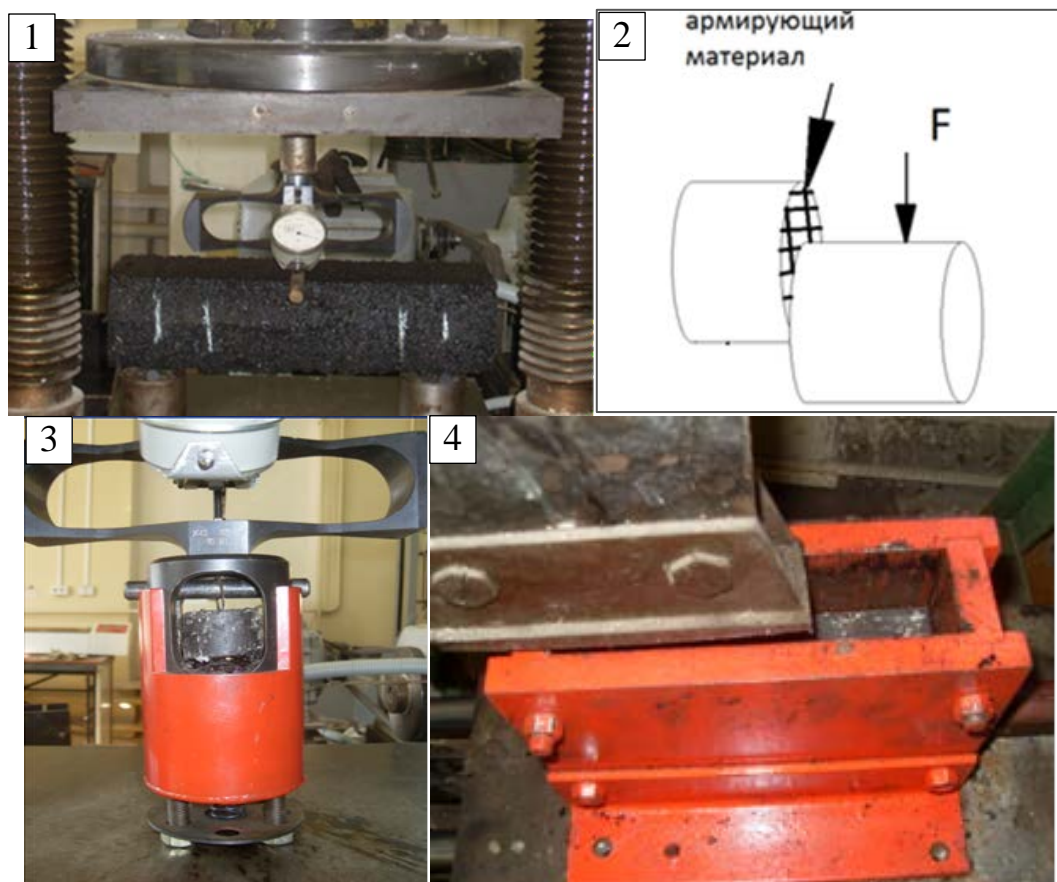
Схемы испытания образцов асфальтобетонного покрытия на:
